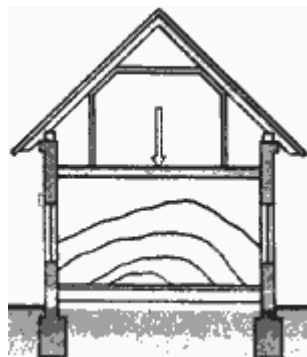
Образование трещин в стенах из-за воздействия на конструкцию перекрытия повышенных нагрузок.
